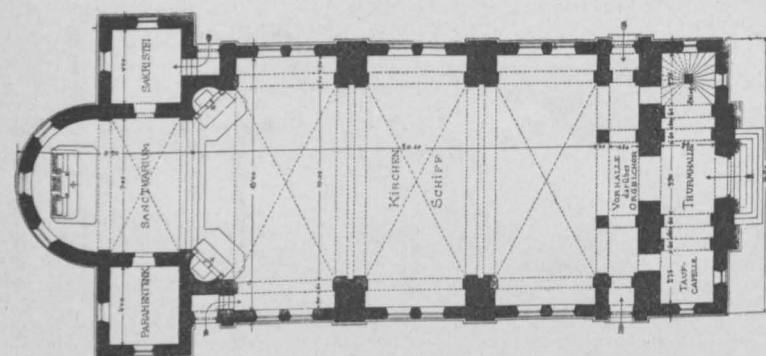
Grundriss der Kirche in Konjica. 1:400.
